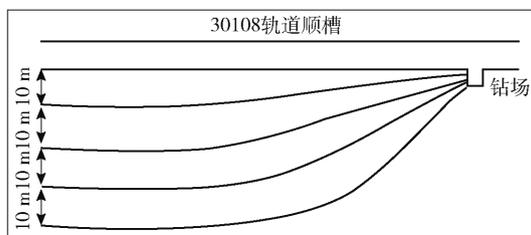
30108轨道顺槽顶板走向高位钻孔平面布置示意图
